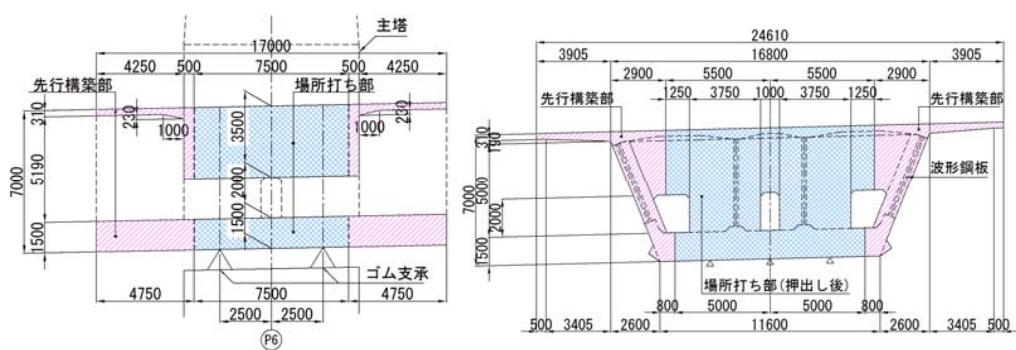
P6 柱頭部構造図（左：側面図、右：断面図（供用 4 車線断面））
